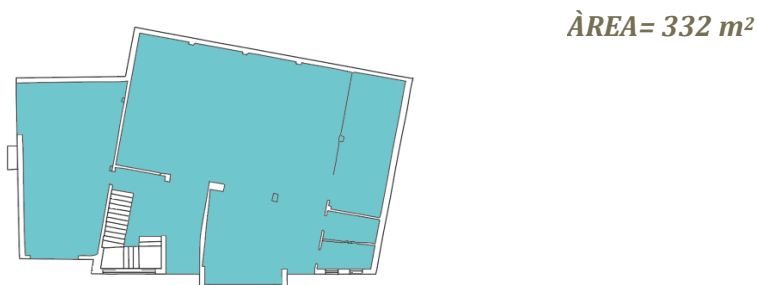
Planta Piso 0 com indicação da área a intervir a azul
